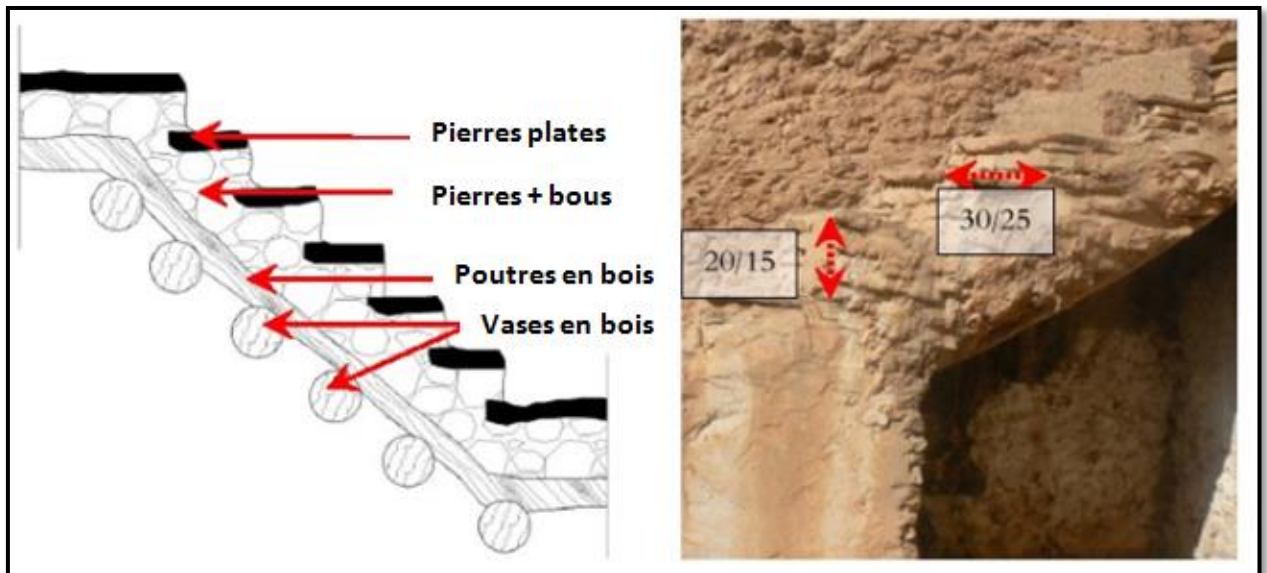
Coupe schématique des escaliers type1.(Source par l'auteur)
